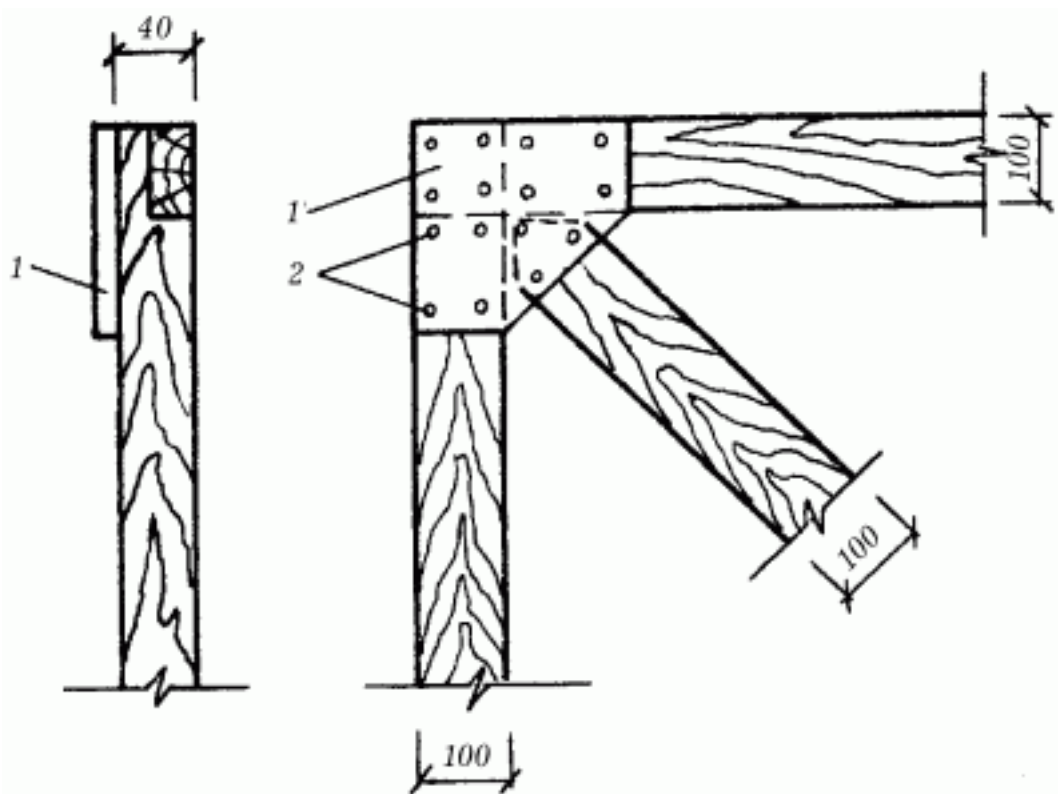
Схема углового соединения рамы калитки: 1 – накладка из фанеры или металла; 2 – гвозди или шурупы.
